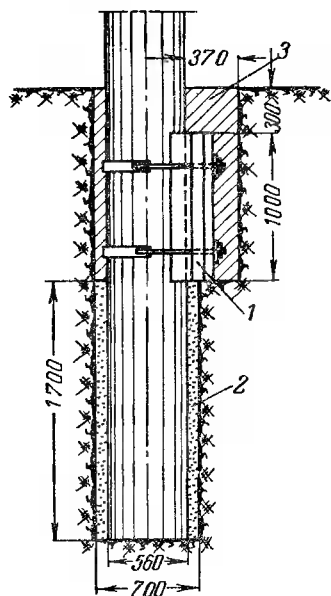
Нижняя часть железобетонной опоры с верхним ригелем.
